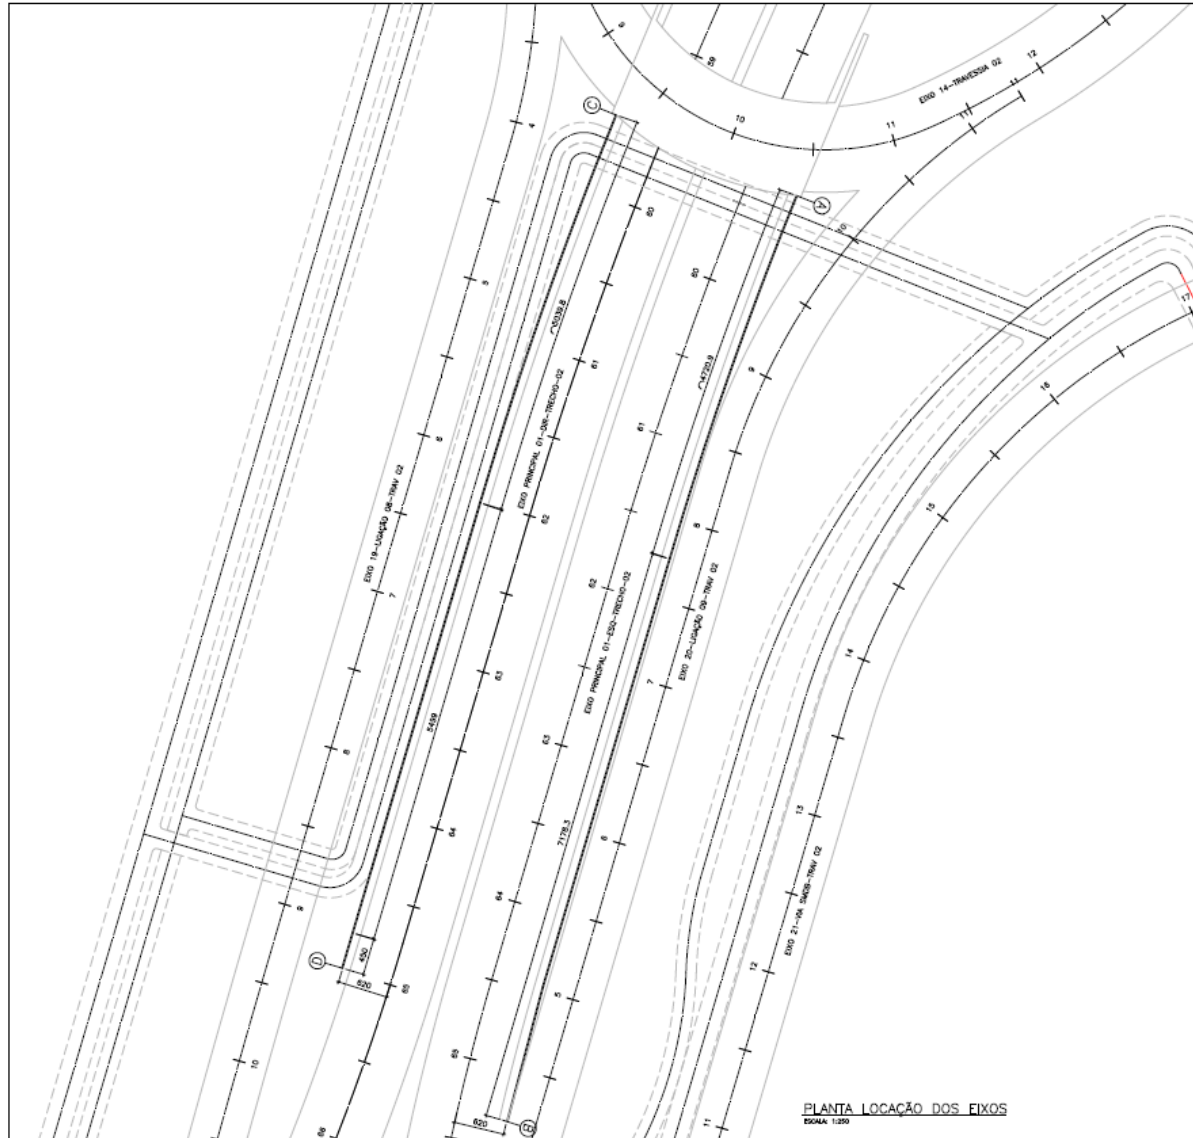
Planta – Locação do Solo Reforçado – Eixos AB e CD
